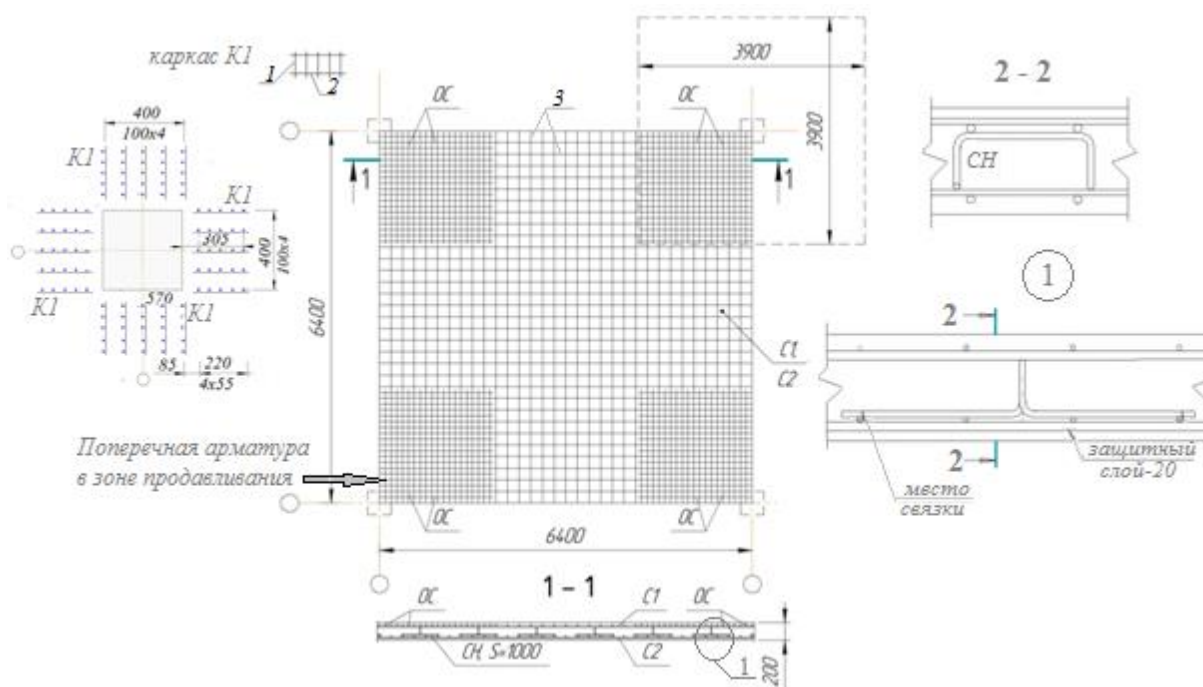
Схема армирования ячейки плоской плиты перекрытия
